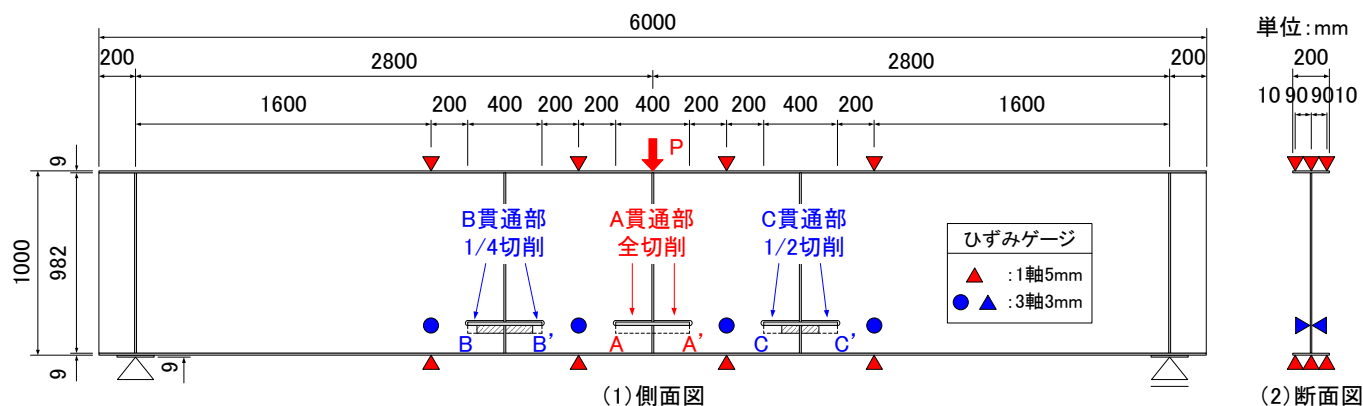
試験体の形状・寸法とひずみゲージ貼付位置
